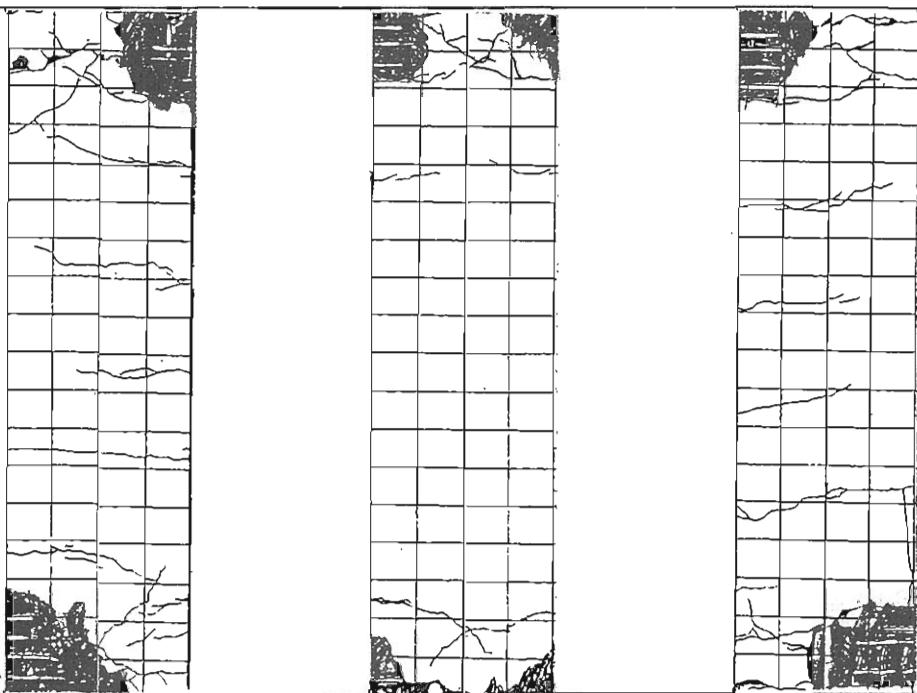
桁体のひび割れ状況展開図 (ケース4、8δy)
